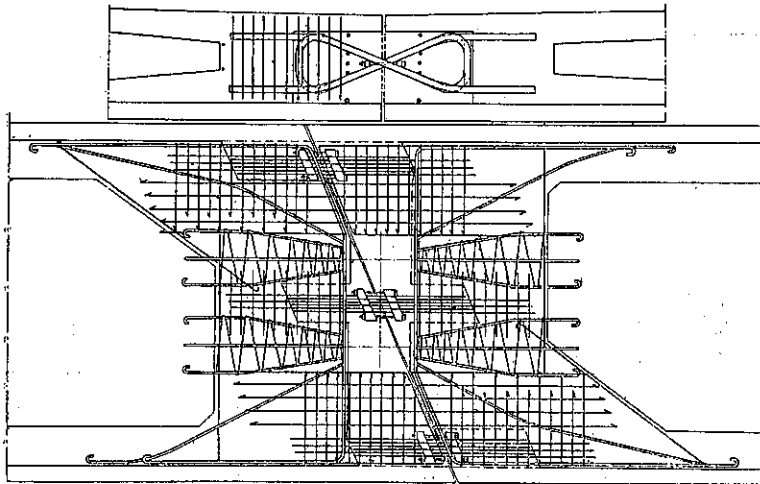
Pisa 市 Bisenzio 河歩道橋 (頂部鉸構造詳細図)
